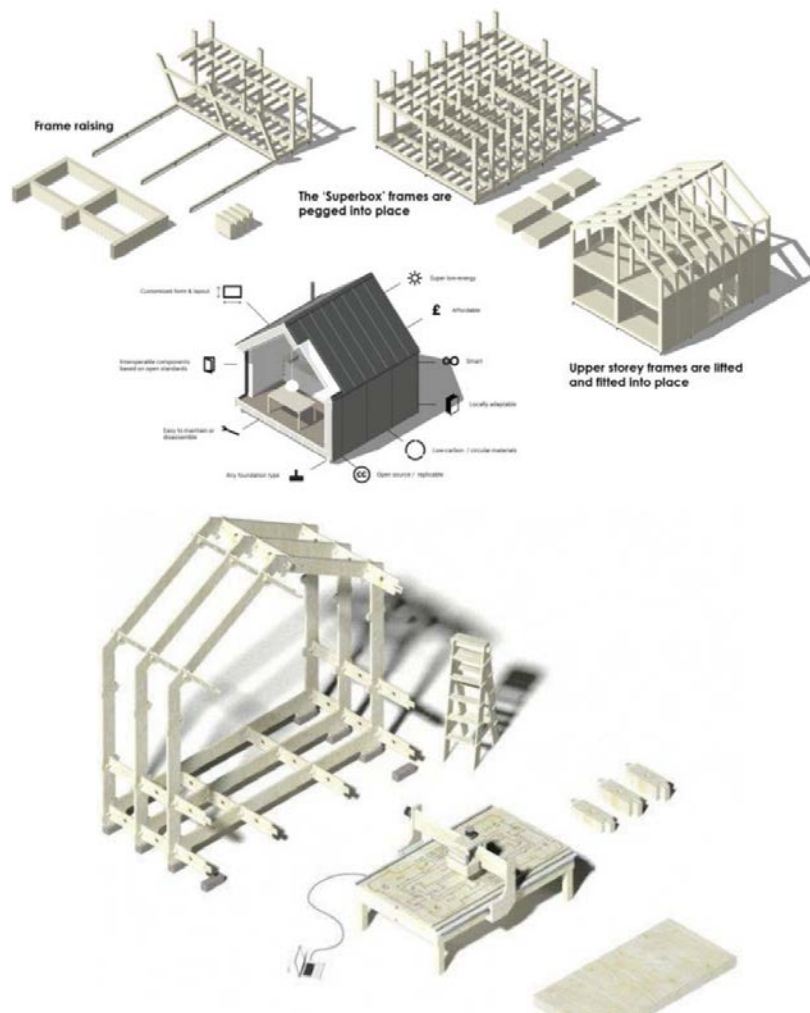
Sistema de montagem da WikiHouse Fonte: Wikihouse (2020)
